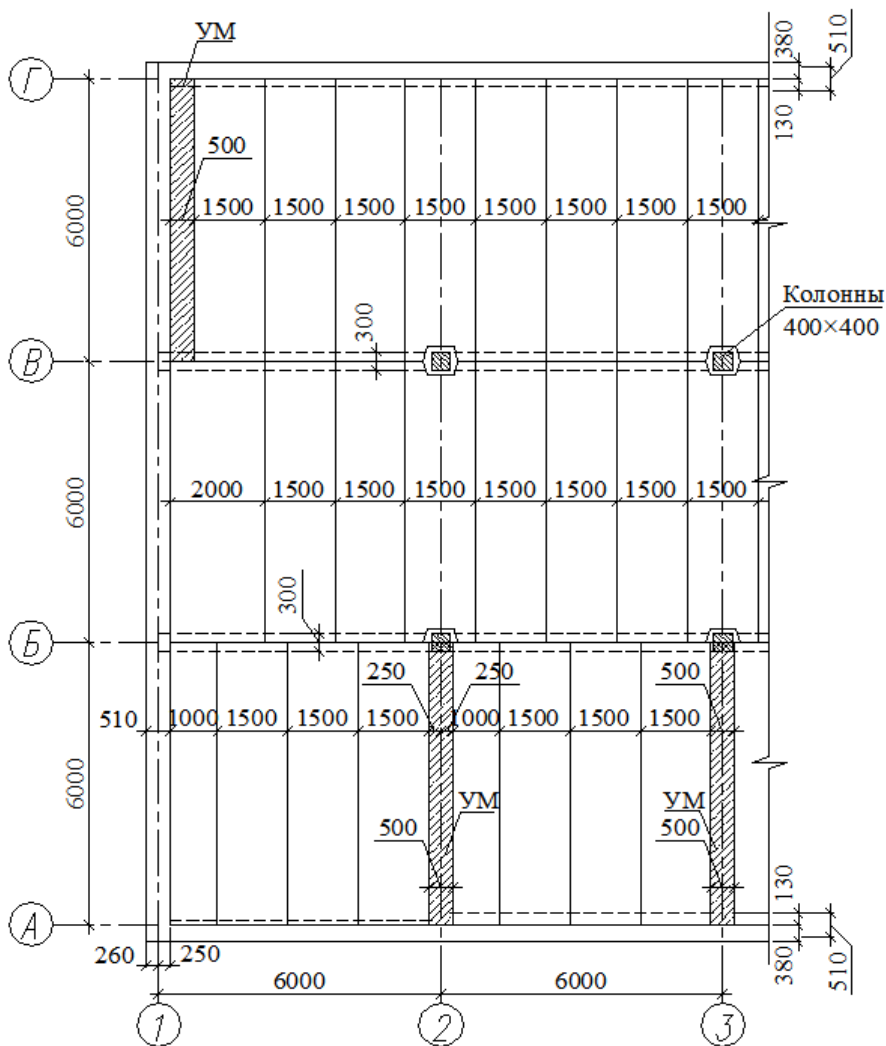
Компонировочная схема раскладки плит перекрытий с продольным расположением ригелей
